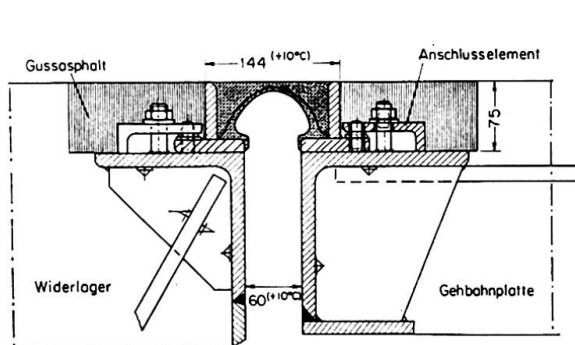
Anschluß des Gehbahnüberganges an die Unterkonstruktion.
